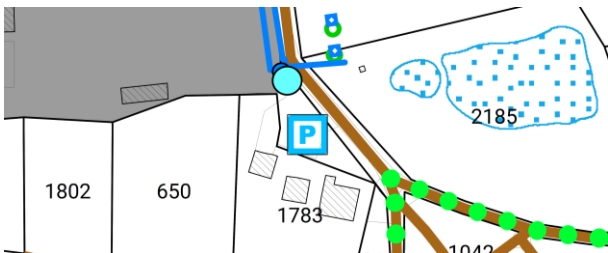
Ausschnitt aus dem revidierten GEP: Geplanter Parkplatz beim Lag (Darstellung R+K)
